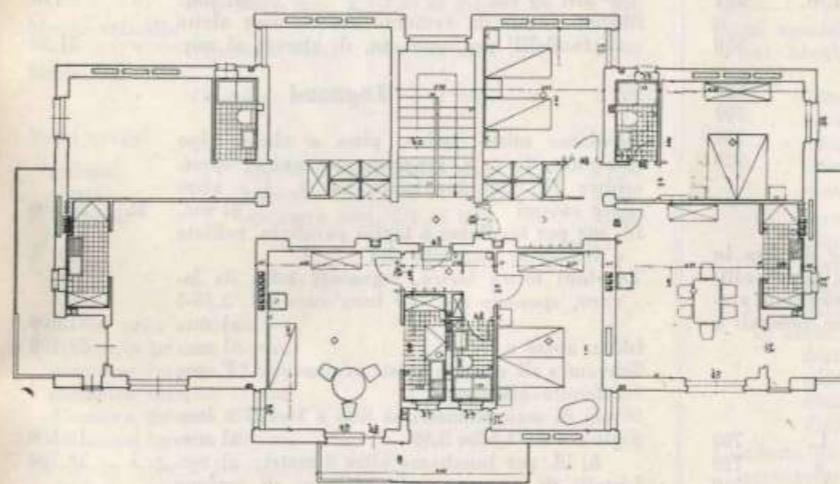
Pianta piano tipo: Motto "Nord-Sud C".
